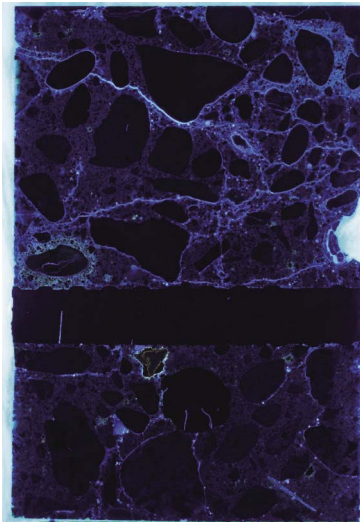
土砂化部とその周辺のコンクリートの状況 (Ki 橋)
